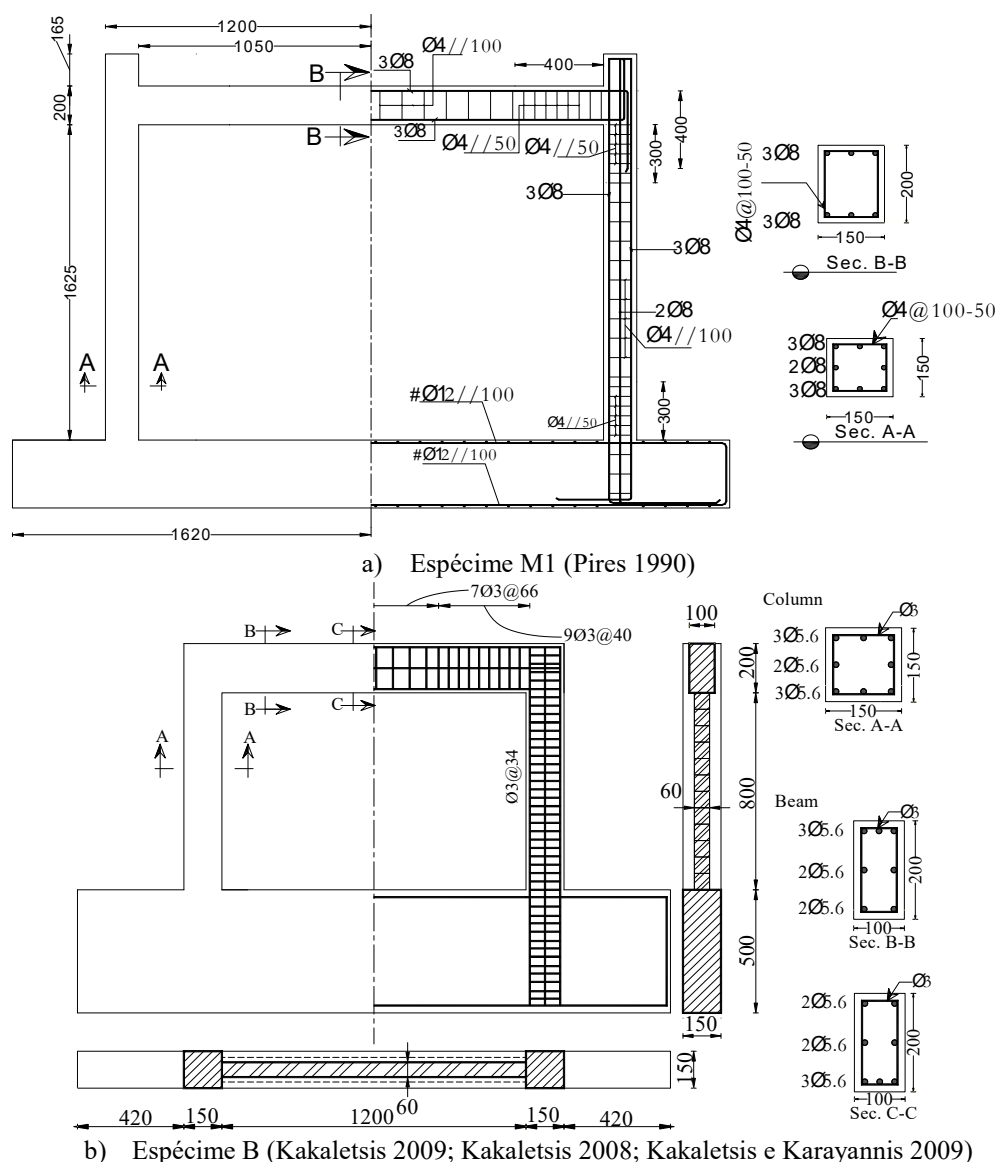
Geometria e pormenores da disposição de armaduras dos espécimes das duas campanhas experimentais
